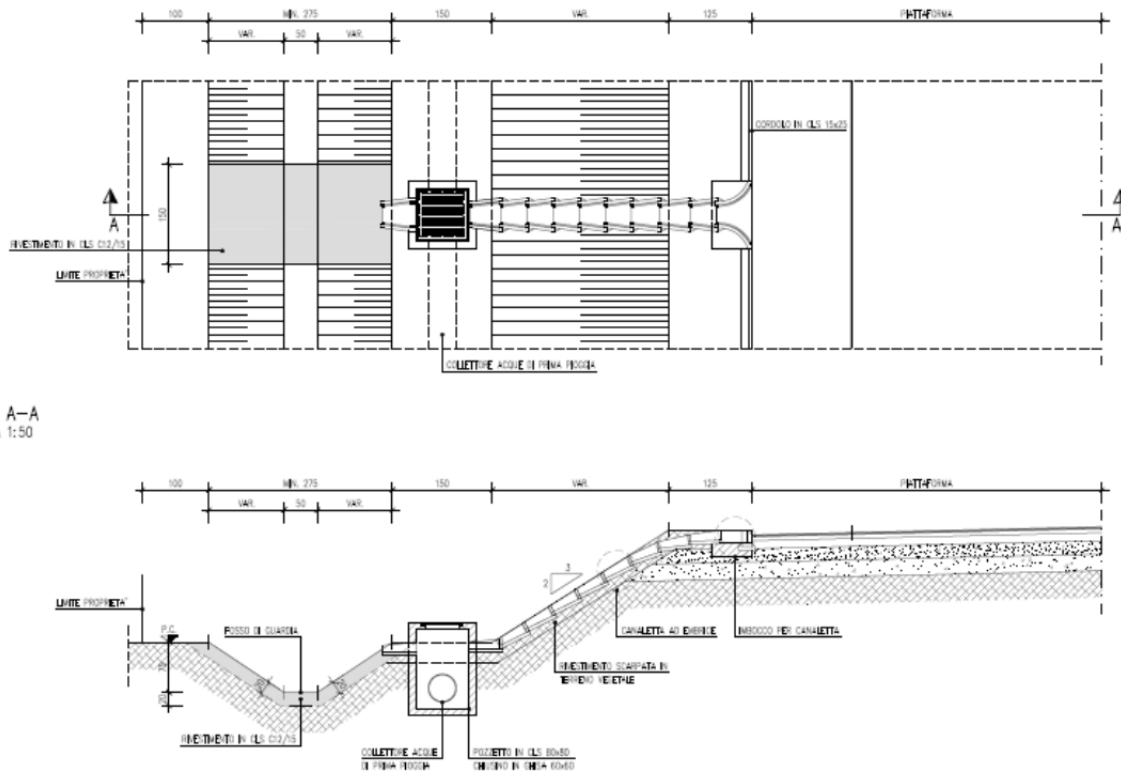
Pozzetti per la raccolta delle acque di prima pioggia da rilevato (dal Progetto preliminare)
